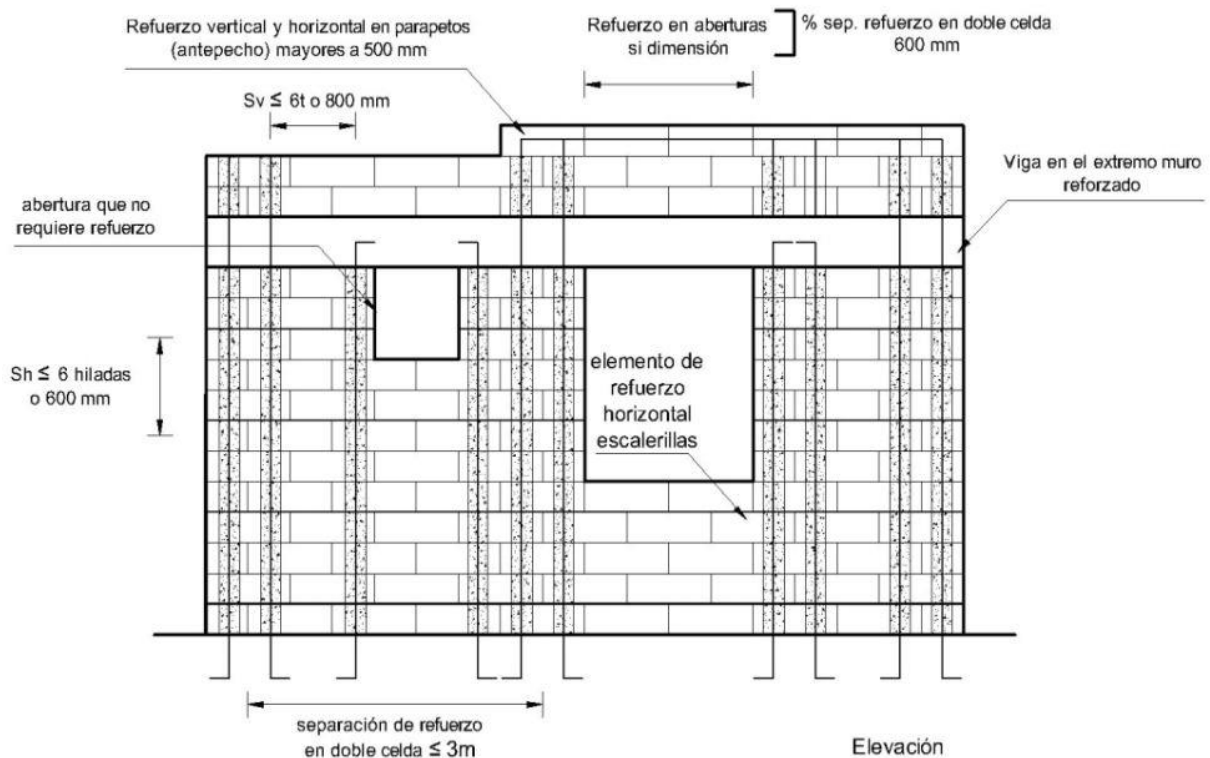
Detalle del reforzamiento vertical, detalle de reforzamiento en aberturas.
